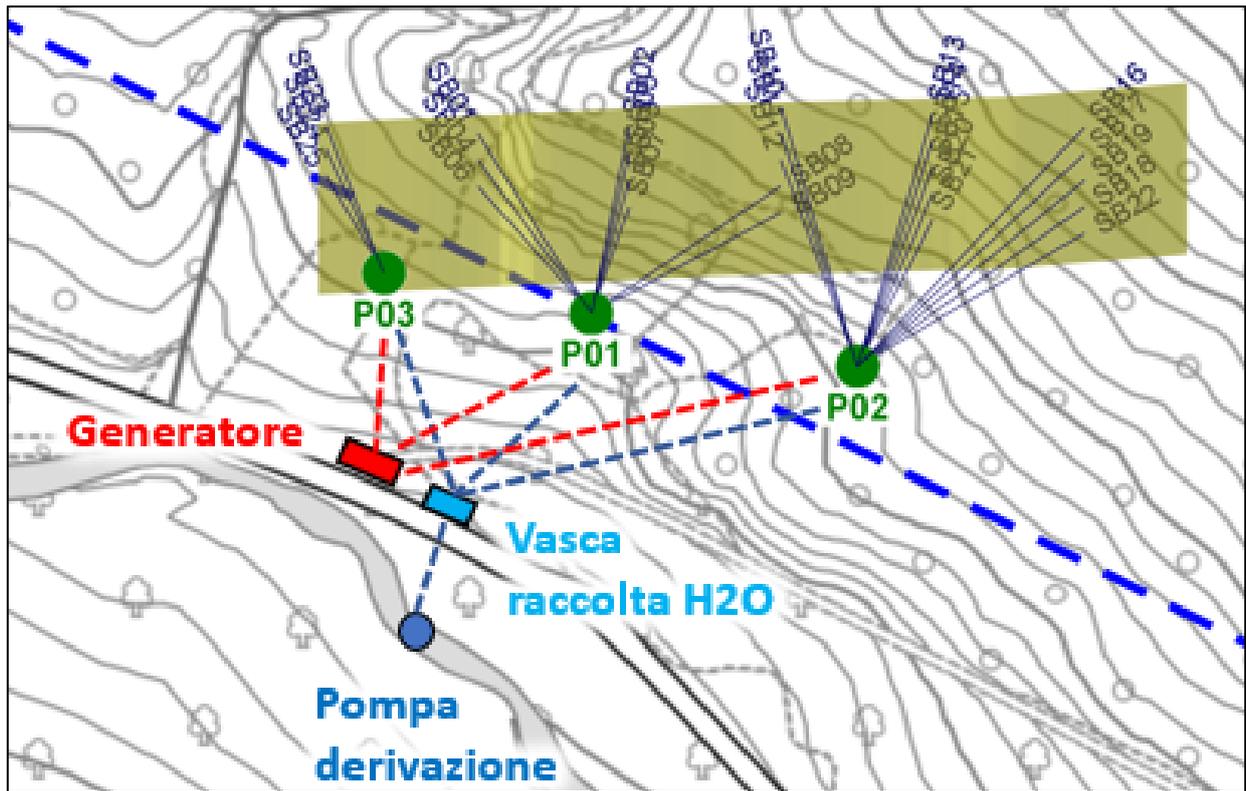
Individuazione piazzole di lavoro Area Santa Barbara
